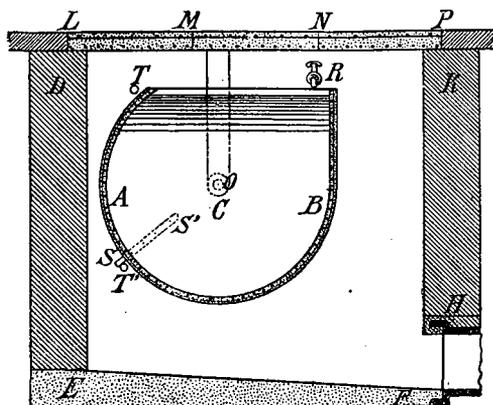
Depósito enterrado para limpia de alcantarillas. (Descarga automática). Corte.
